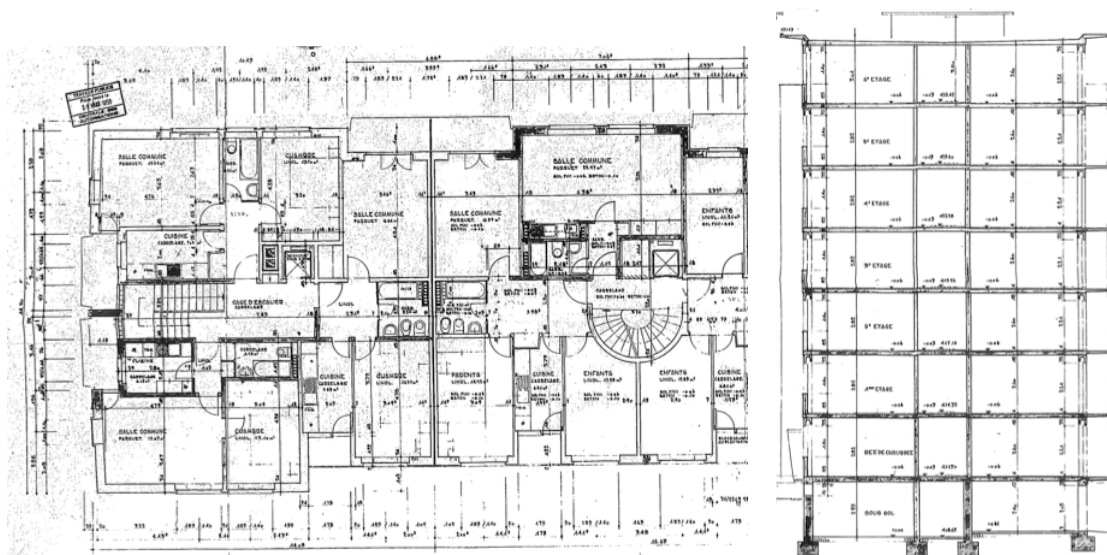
Exemple de plan de bâtiments en maçonnerie de briques avec planchers rigides en béton armé⁵³
